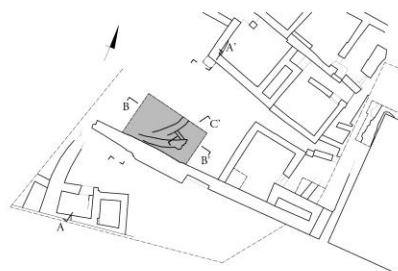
Area ad W del Bastione – Pianta
